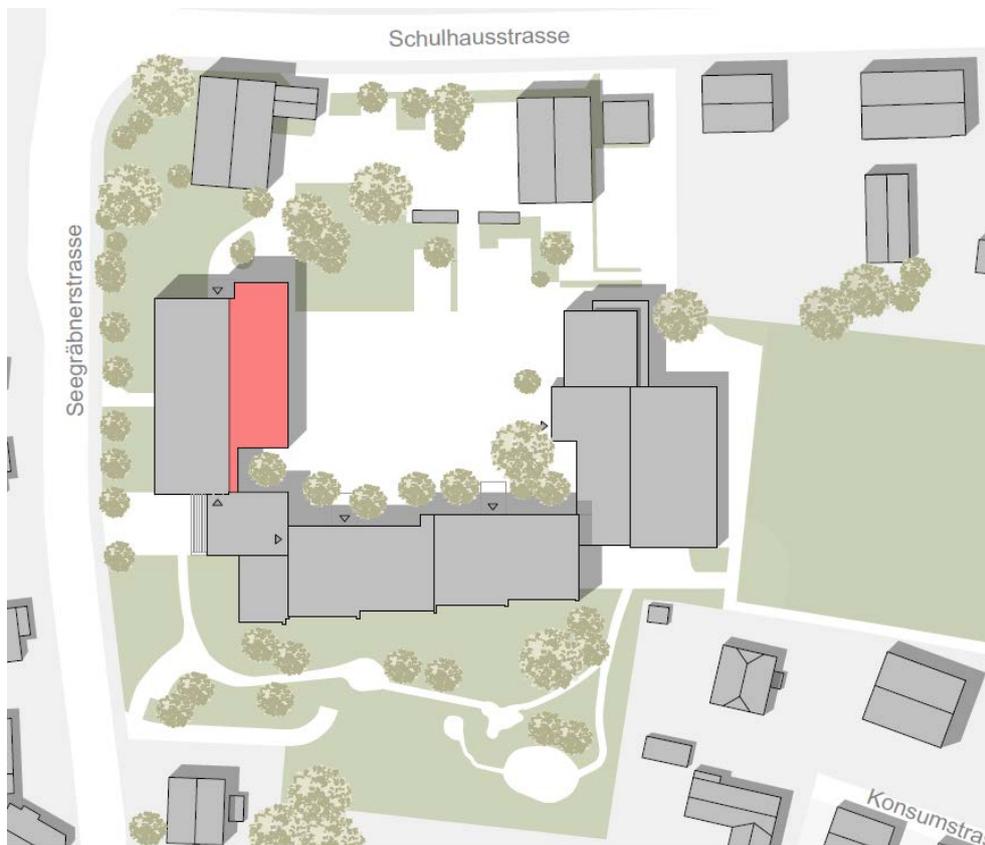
Situation mit Erweiterung (Planstand TU-Ausschreibung)
